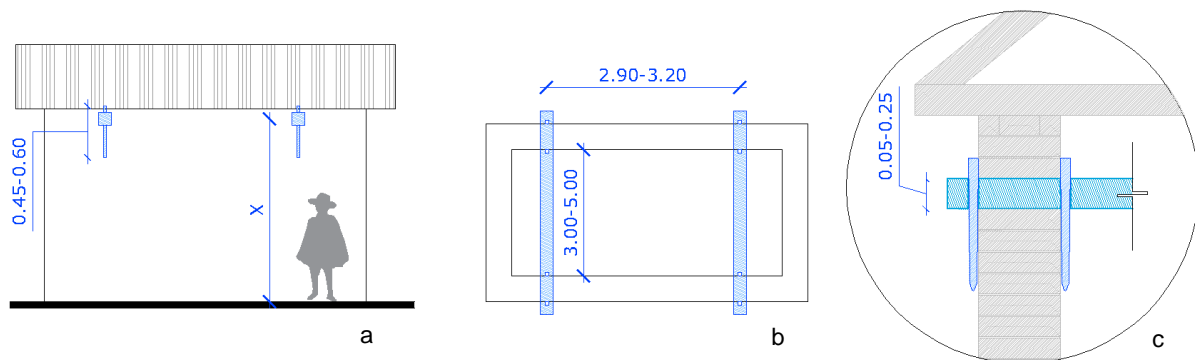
a) Dispositivo DP instalado a la altura del alero. b) Dimensiones de dispositivos en planta c) Detalle de dispositivo sección rectangular (Fuente: Archivo propio)
